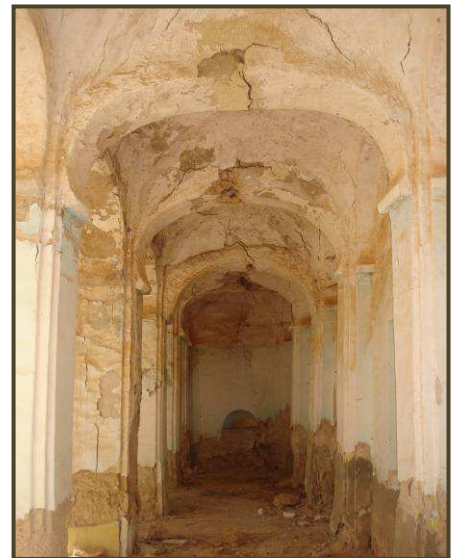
Maison en terre enduite au ciment, Maatkas (Source : Auteur).
